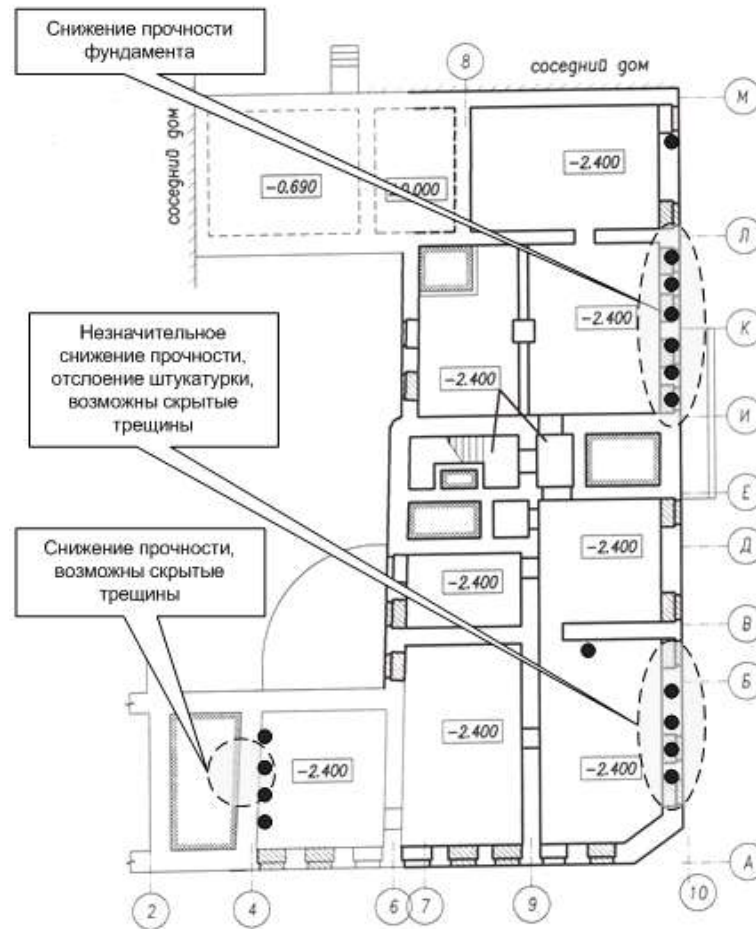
Схема-фрагмент плана здания с выделенными зонами ослабленной бутовой кладки фундаментов после предварительных геофизических обследований
